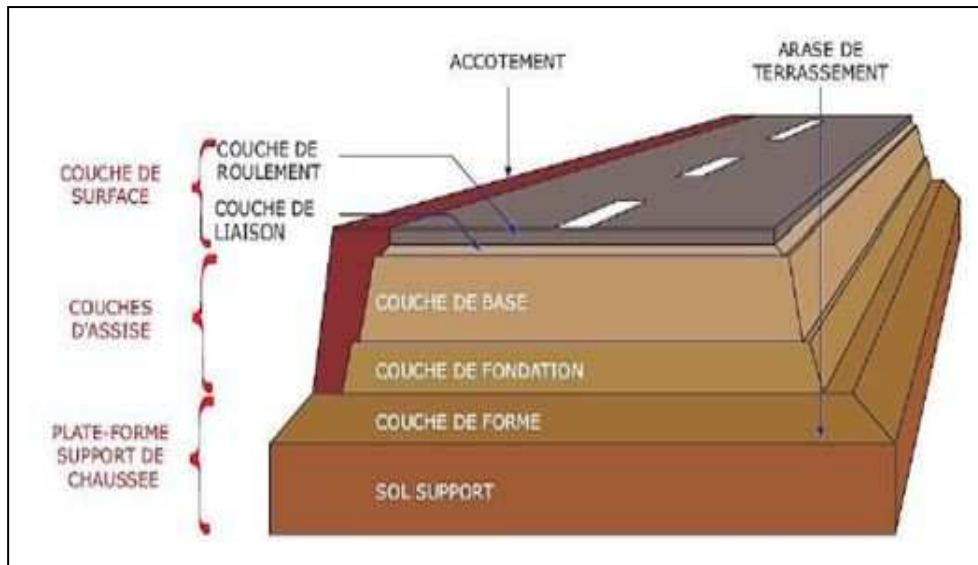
Les différentes couches d'une chaussée (Pouteau, 2004)[18]
